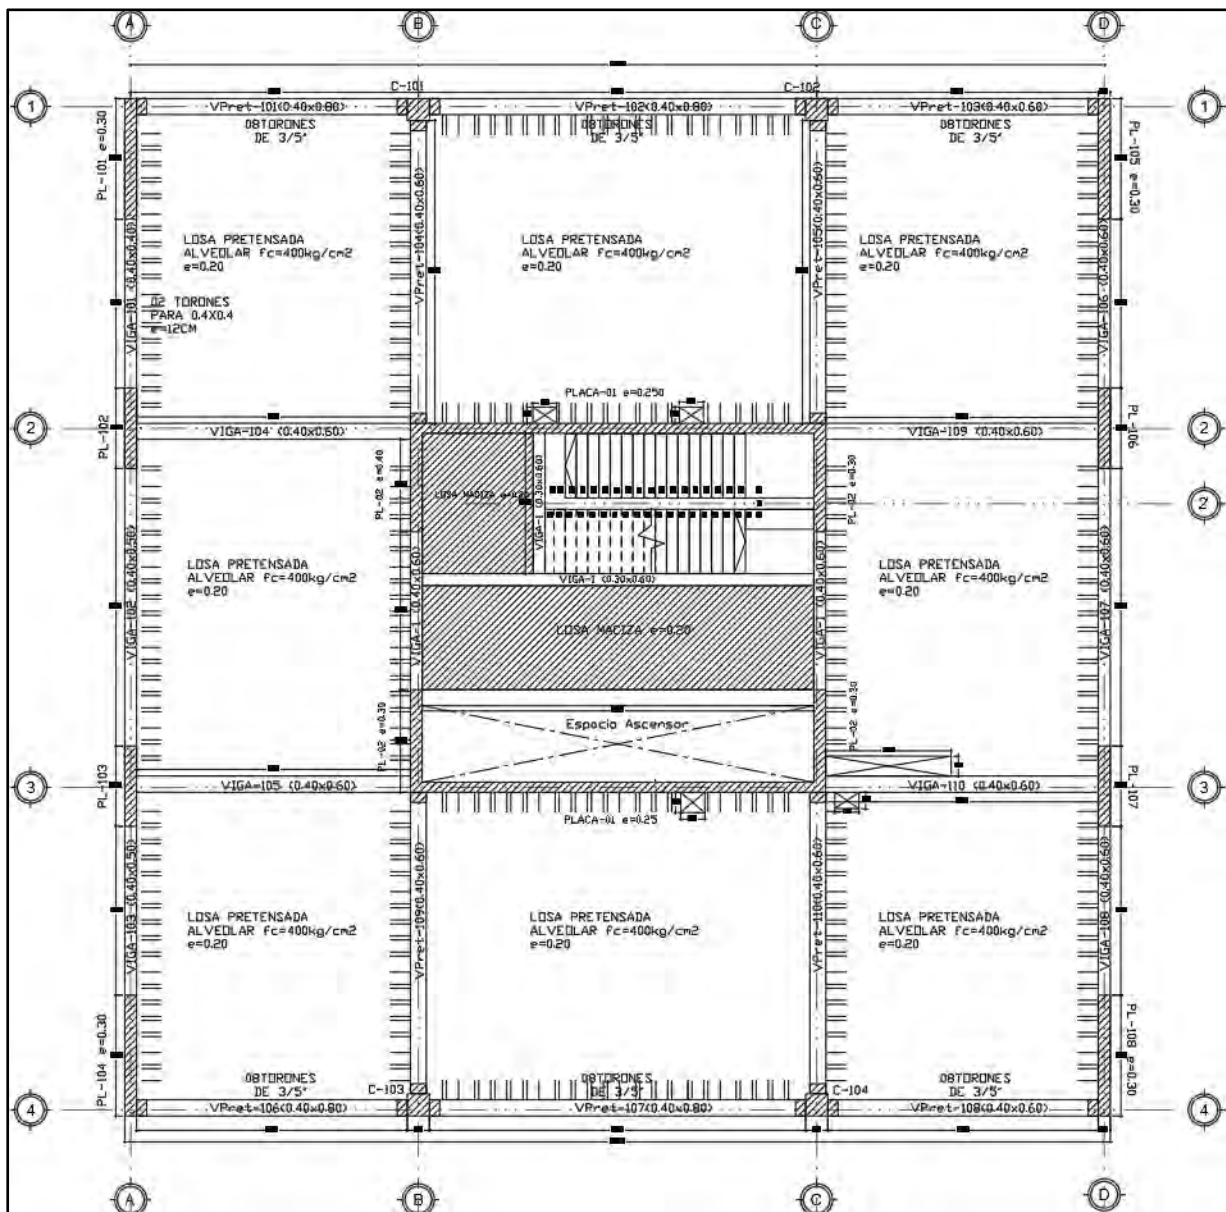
Plano de piso típico con sus respectivos elementos estructurales (Fuente propia)
